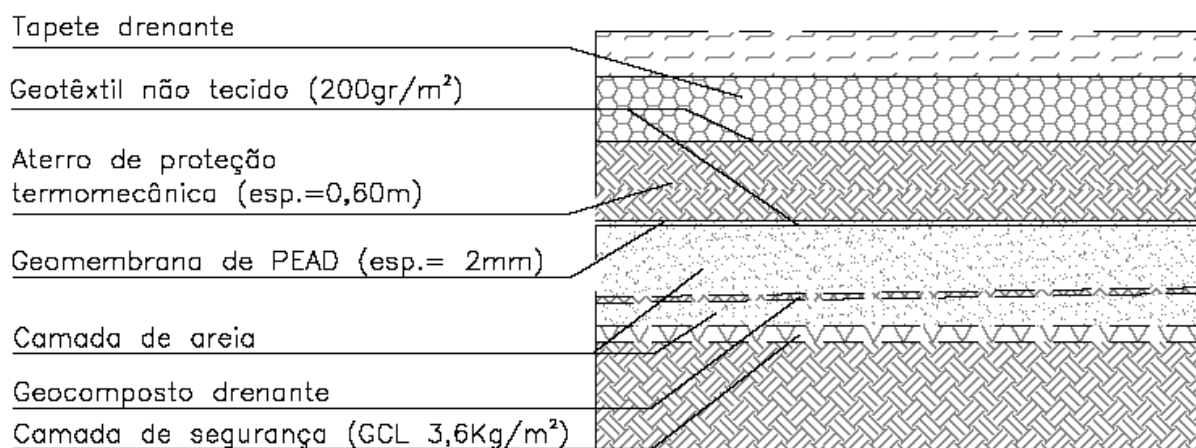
Sistema de impermeabilização de base (liner) para o Aterro Sanitário de Piracicaba-SP.
